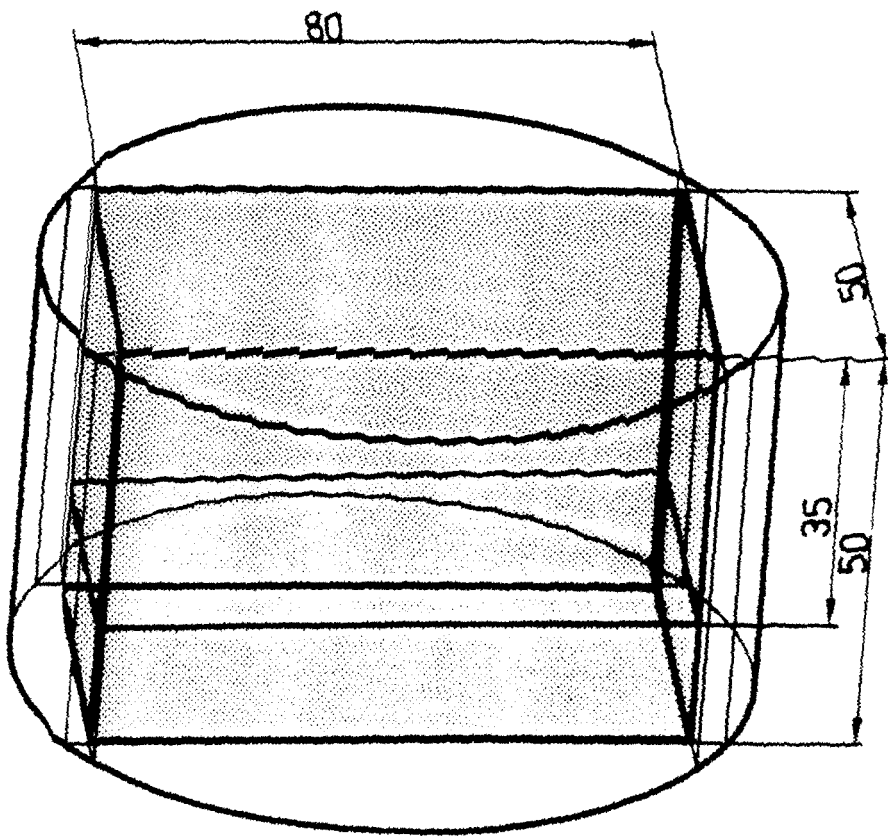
Präparation der Betonproben nach dem Beaufschlagen.
